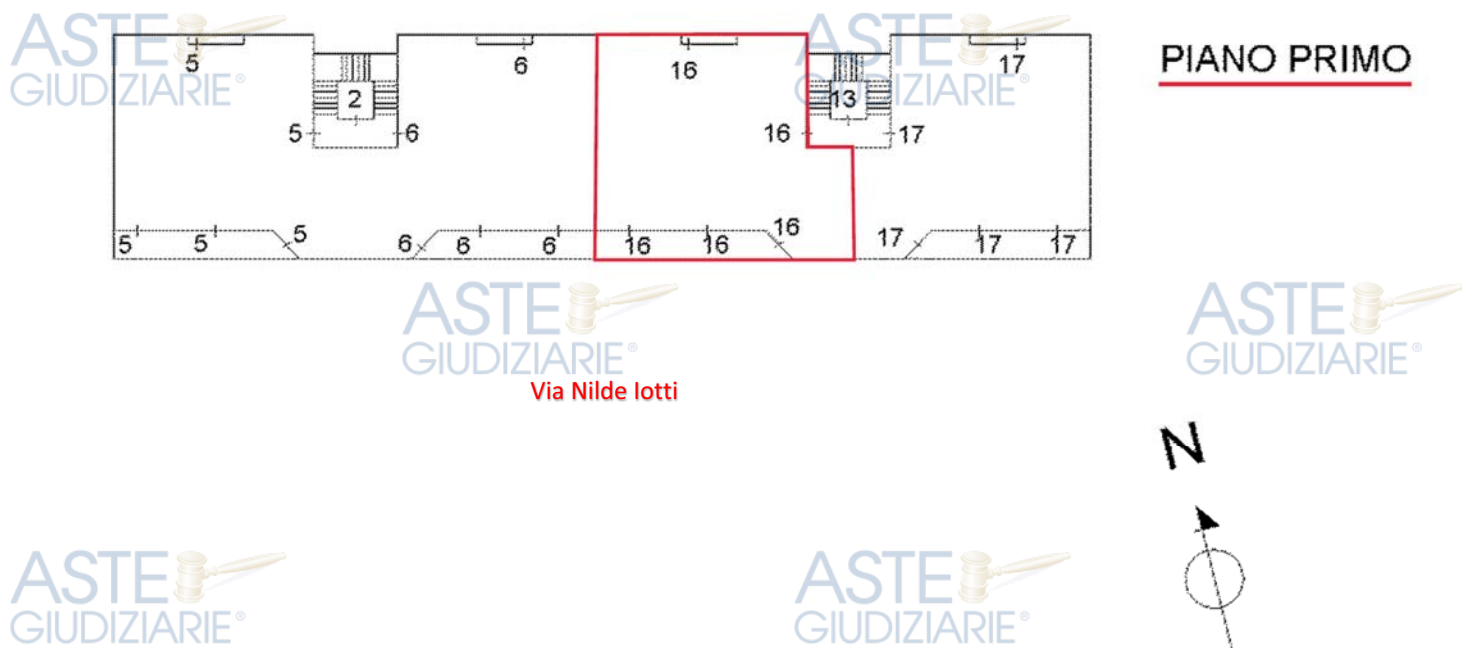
Posizione del cespite all'interno del Fabbricato (Stralcio dell'elaborato planimetrico catastale)
